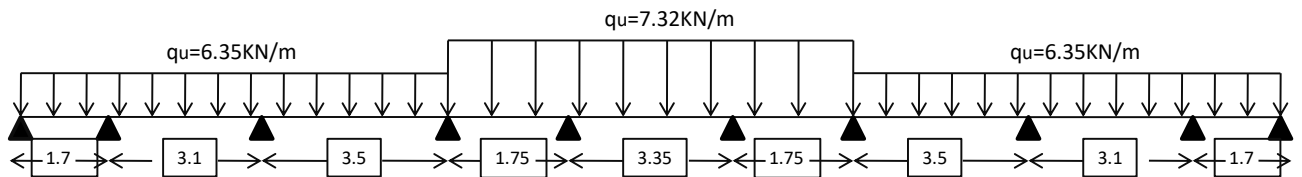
Schéma statique de la poutrelle à L'ELU
